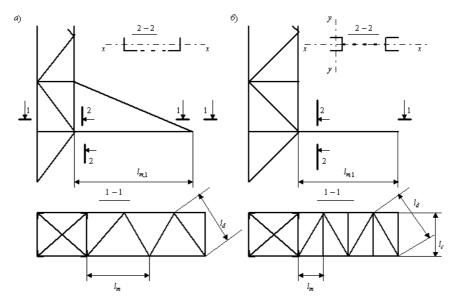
Схемы траверс а— с треугольной решеткой; б— то же, со стойками
